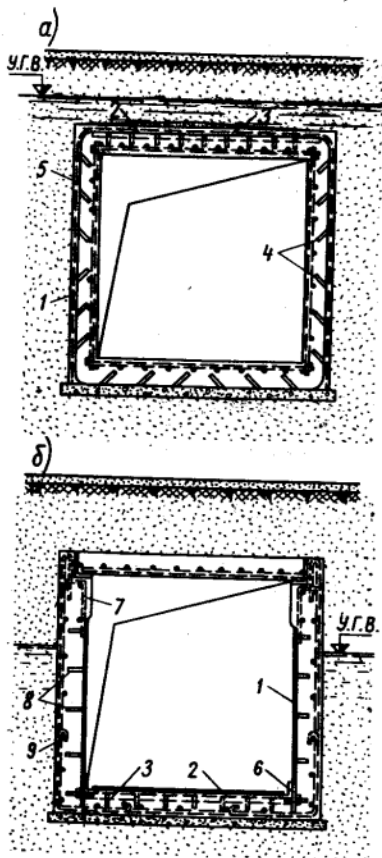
Армирование тоннеля ненапрягаемой листовой арматурой:
